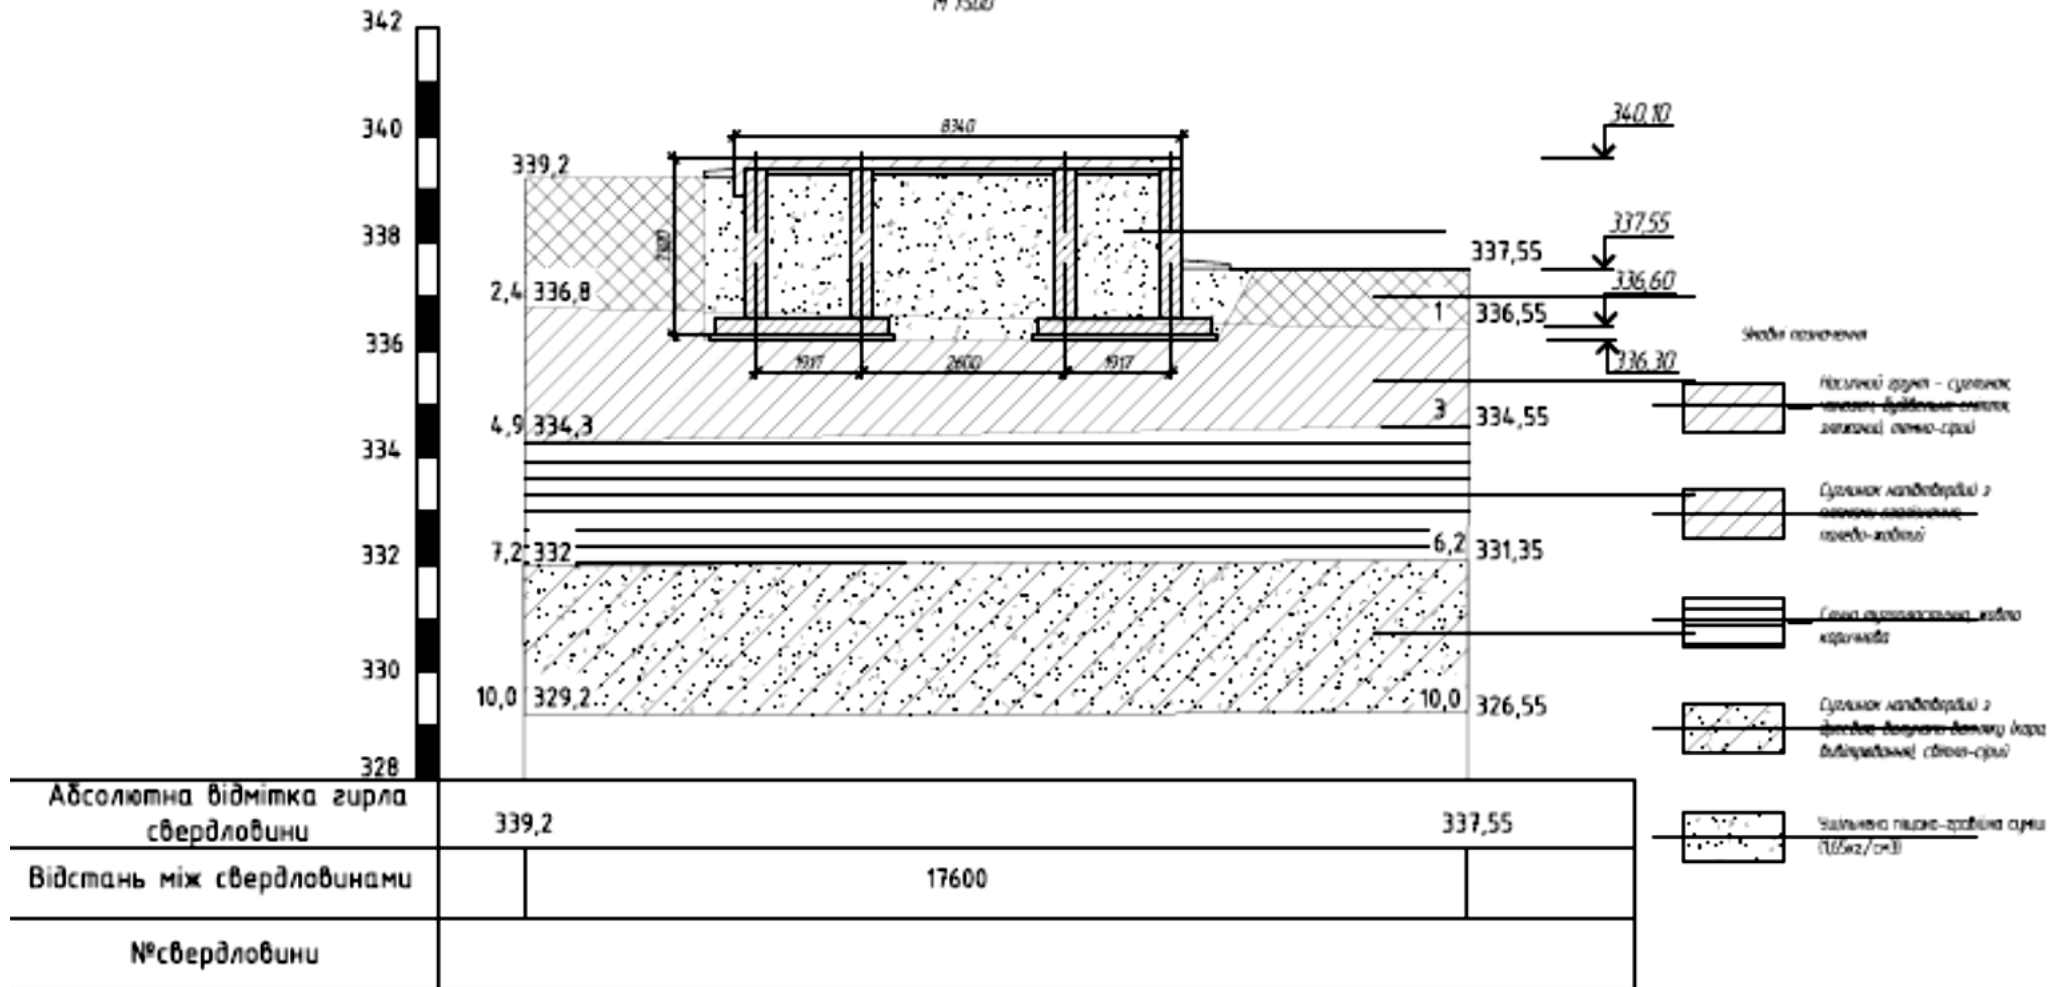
Геологічний розріз та конструкція фундаменту хопера
